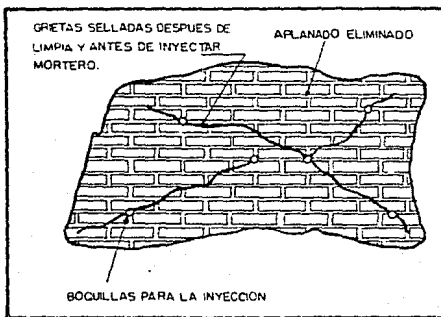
Inyección de grietas en muros de mampostería.
